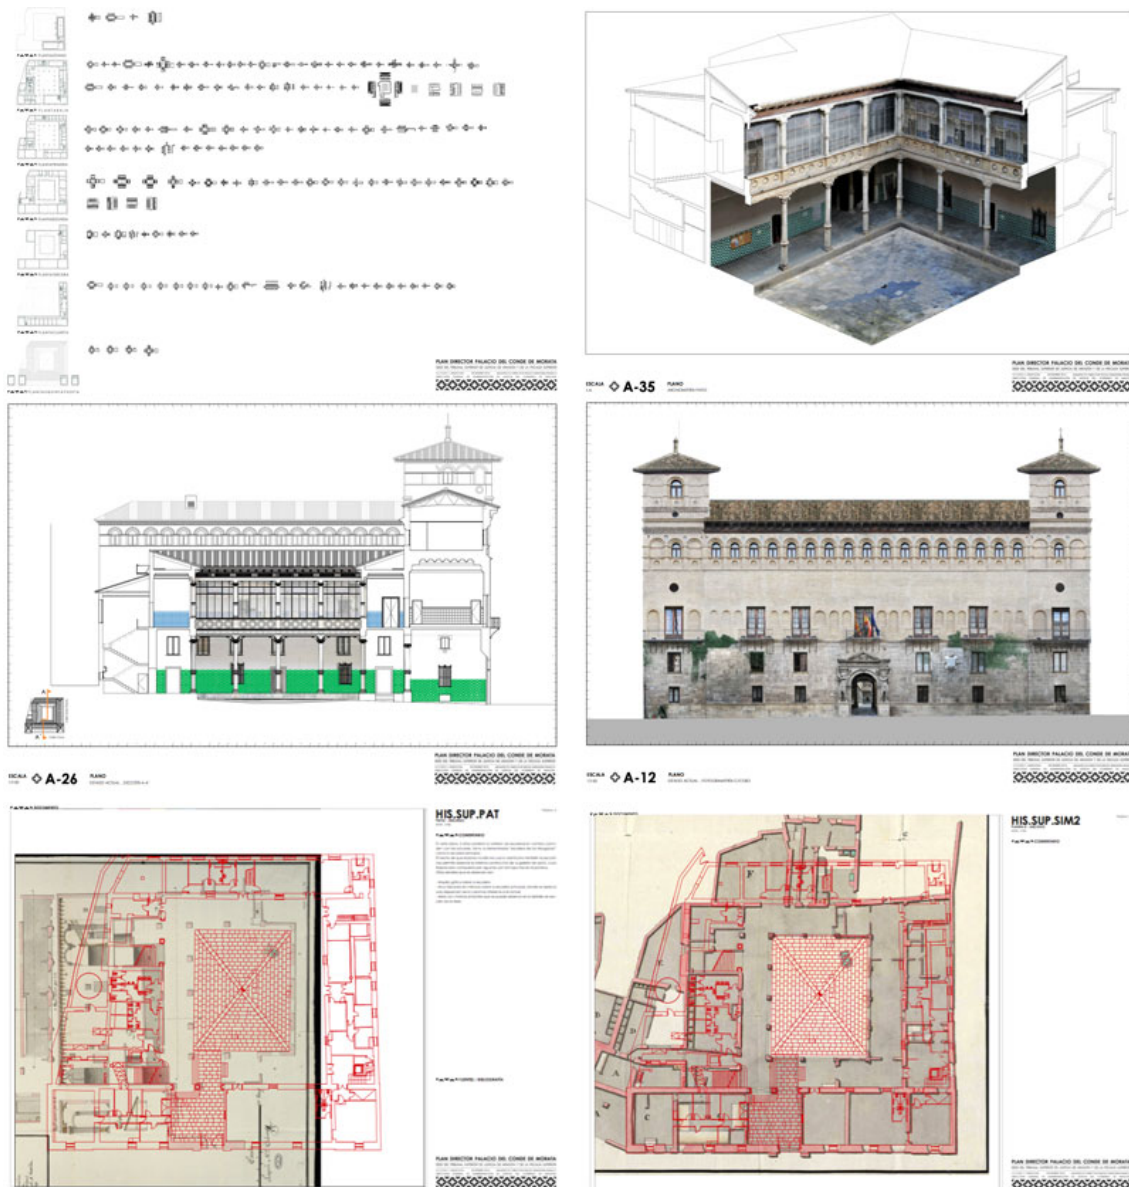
Fichas del Plan Director. Atlas de espacios desarrollado. Levantamiento general. Perspectiva fotogramétrica patio. Sección por patio. Fotogrametría alzado C/Coso. Plano J.M^a.Cabrera 1798 (AGS). Plano proyecto de ampliación (no realizada) 1793 (AGS).
